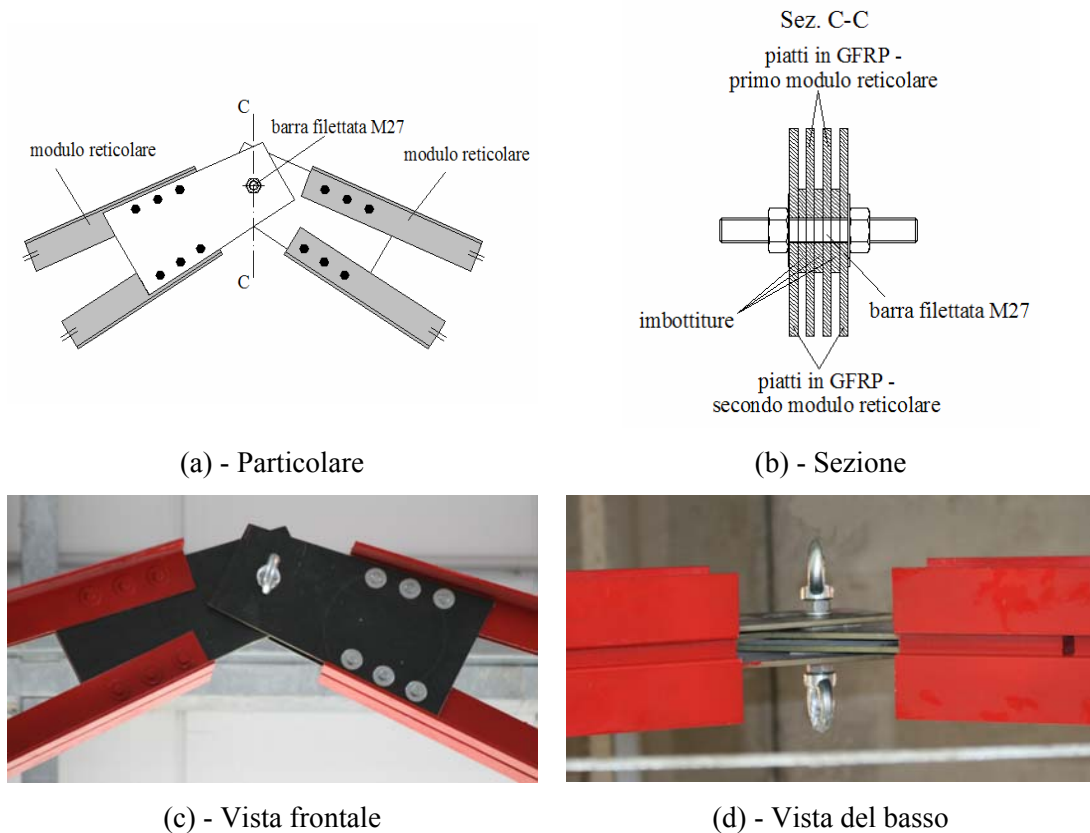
Particolare (a), sezione (b) e foto (c, d) del collegamento tra due moduli reticolari.
